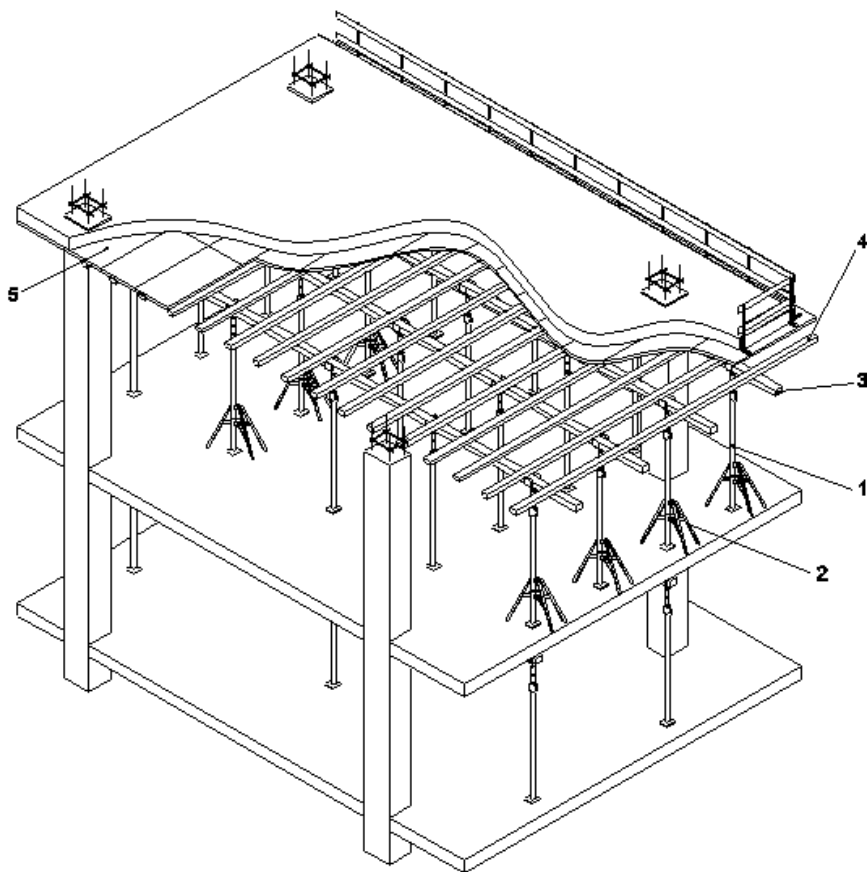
Опалубка перекрытия на основе телескопических стоек:
